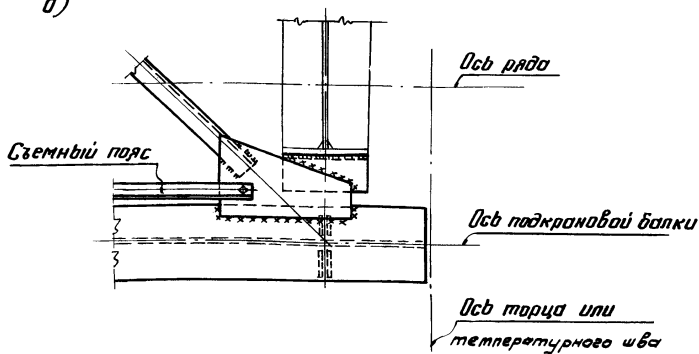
Крепление верхнего пояса неразрезных подкрановых балок и концевых разрезных подкрановых балок к крану при наличии тормозных ферм:
